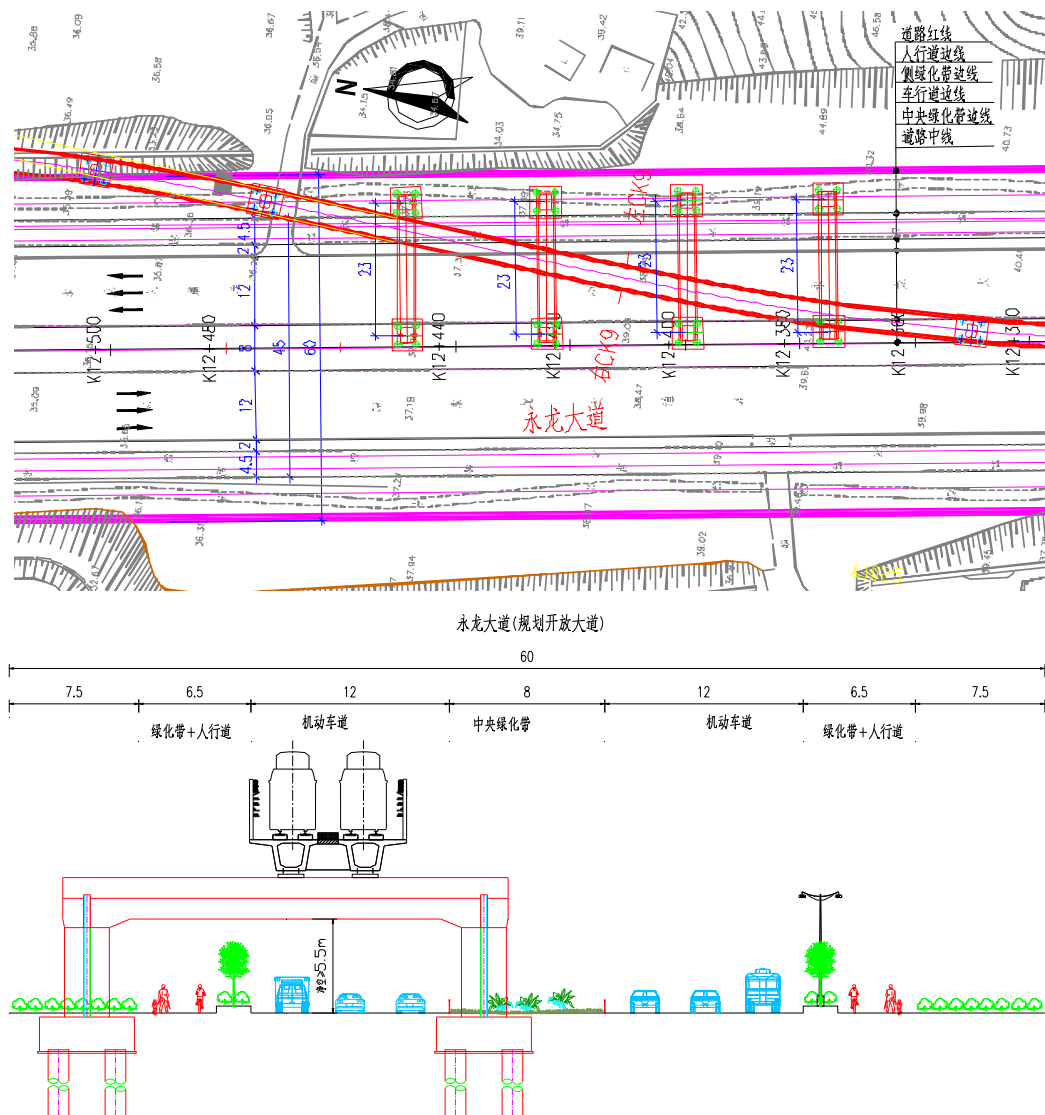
跨永龙大道（规划开放大道）高架段平面、立面图
